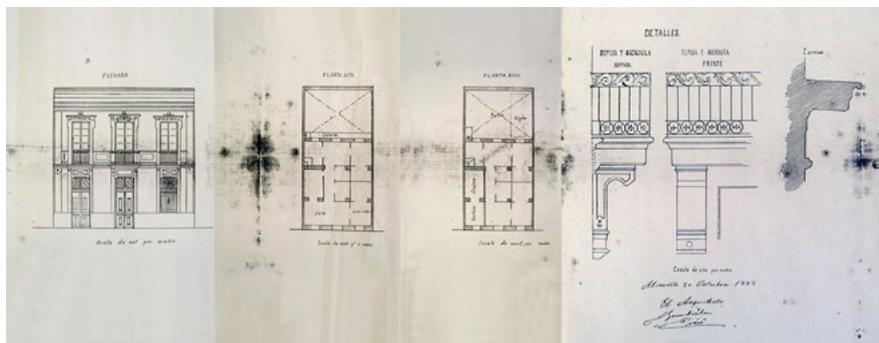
Plano de alzado, plantas y detalles constructivos de una casa (arquitecto Guardiola Picó, 1883). Fuente: Archivo Histórico Municipal de Alicante.
